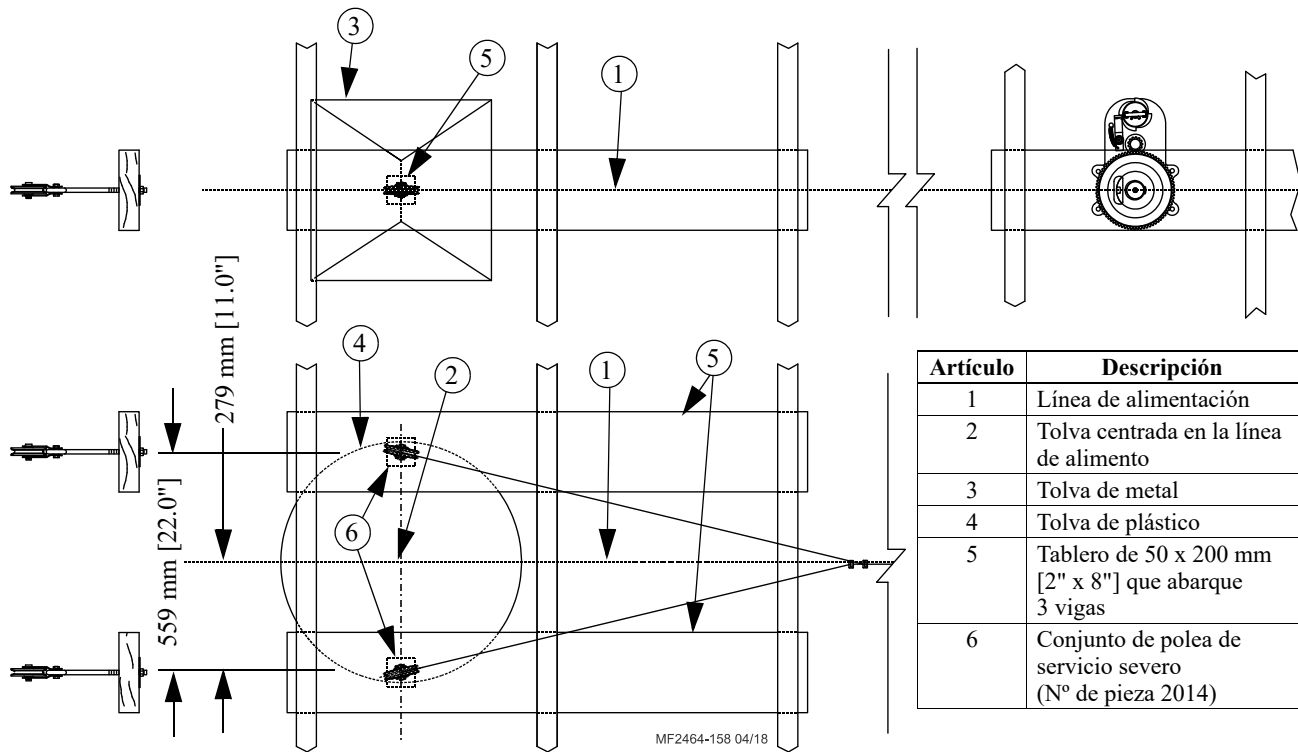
Instalación de cables en ubicaciones de tolvas (construcciones de madera)
